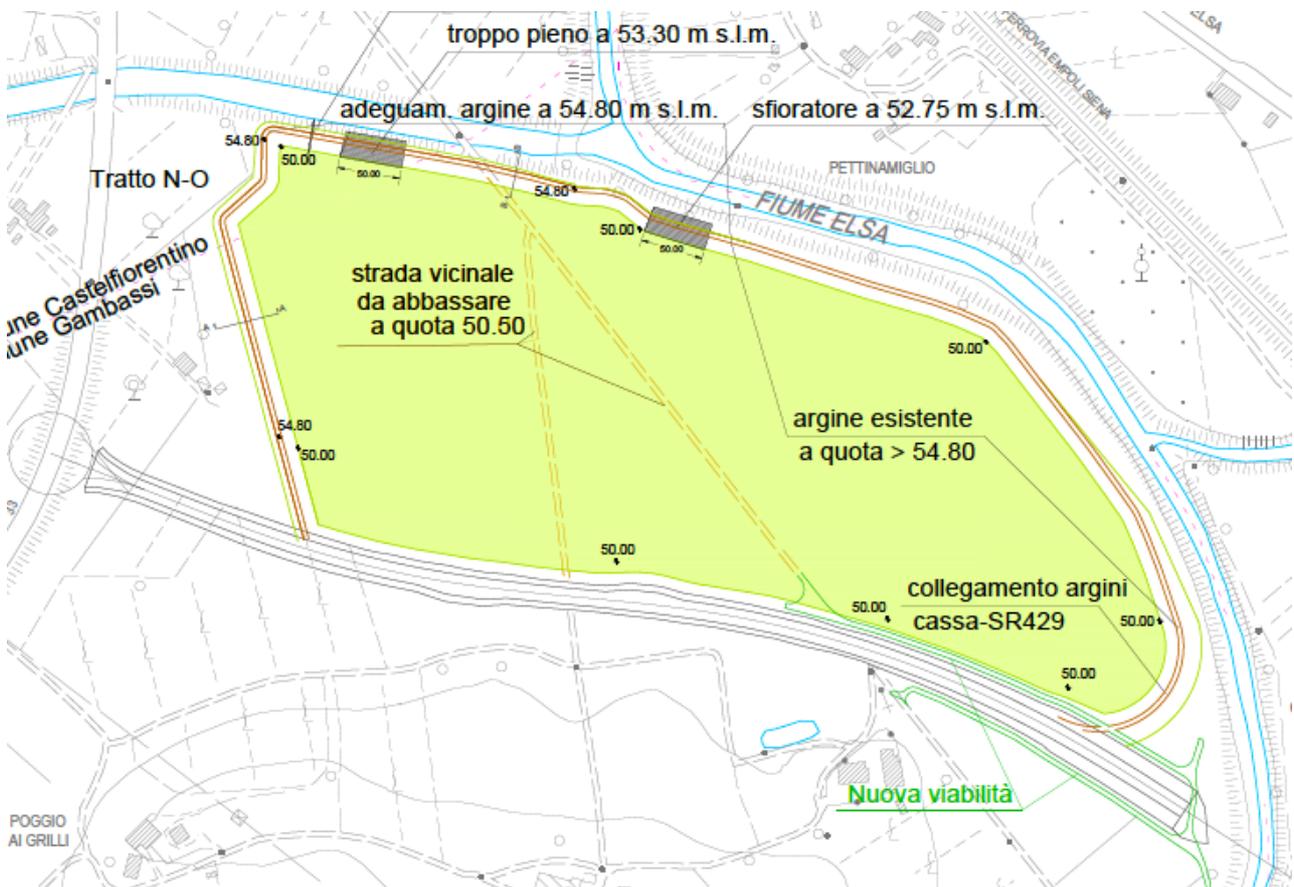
Planimetria degli argini della cassa di espansione Nord.
